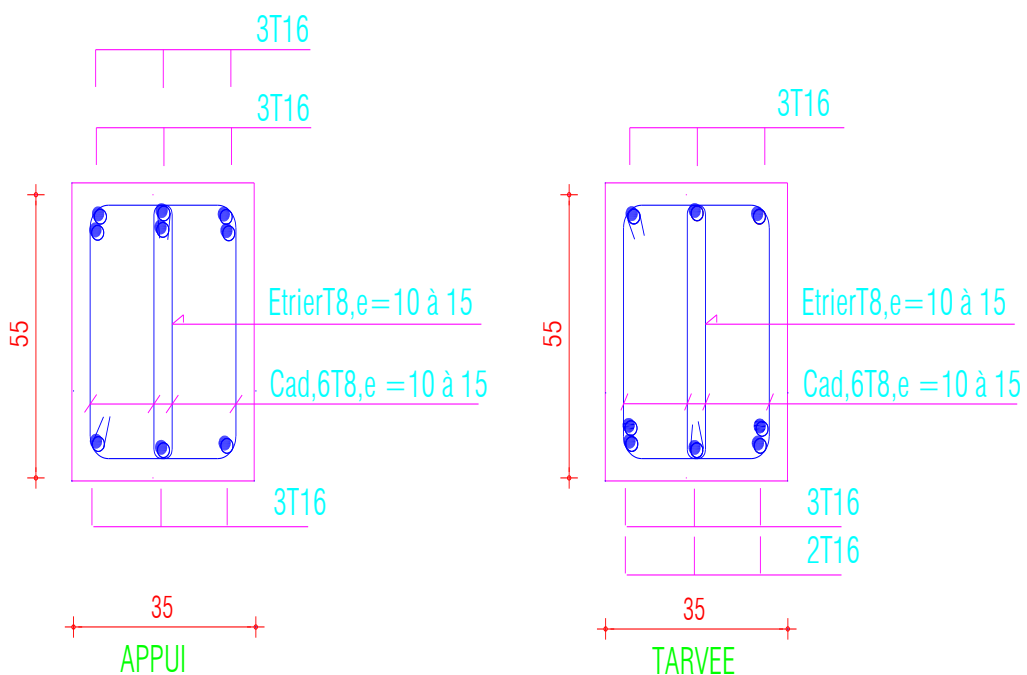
Ferrailage poutre secondaire (35x55)
